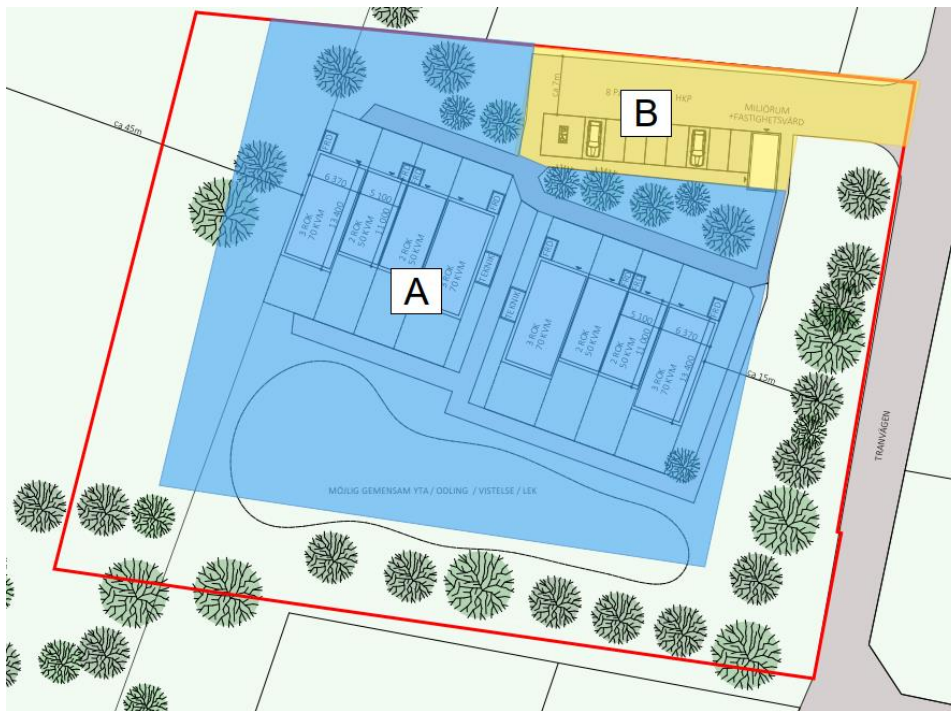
Utkast till plankarta tillhandahållet av Sölvesborgs kommun 2024-12-19.
